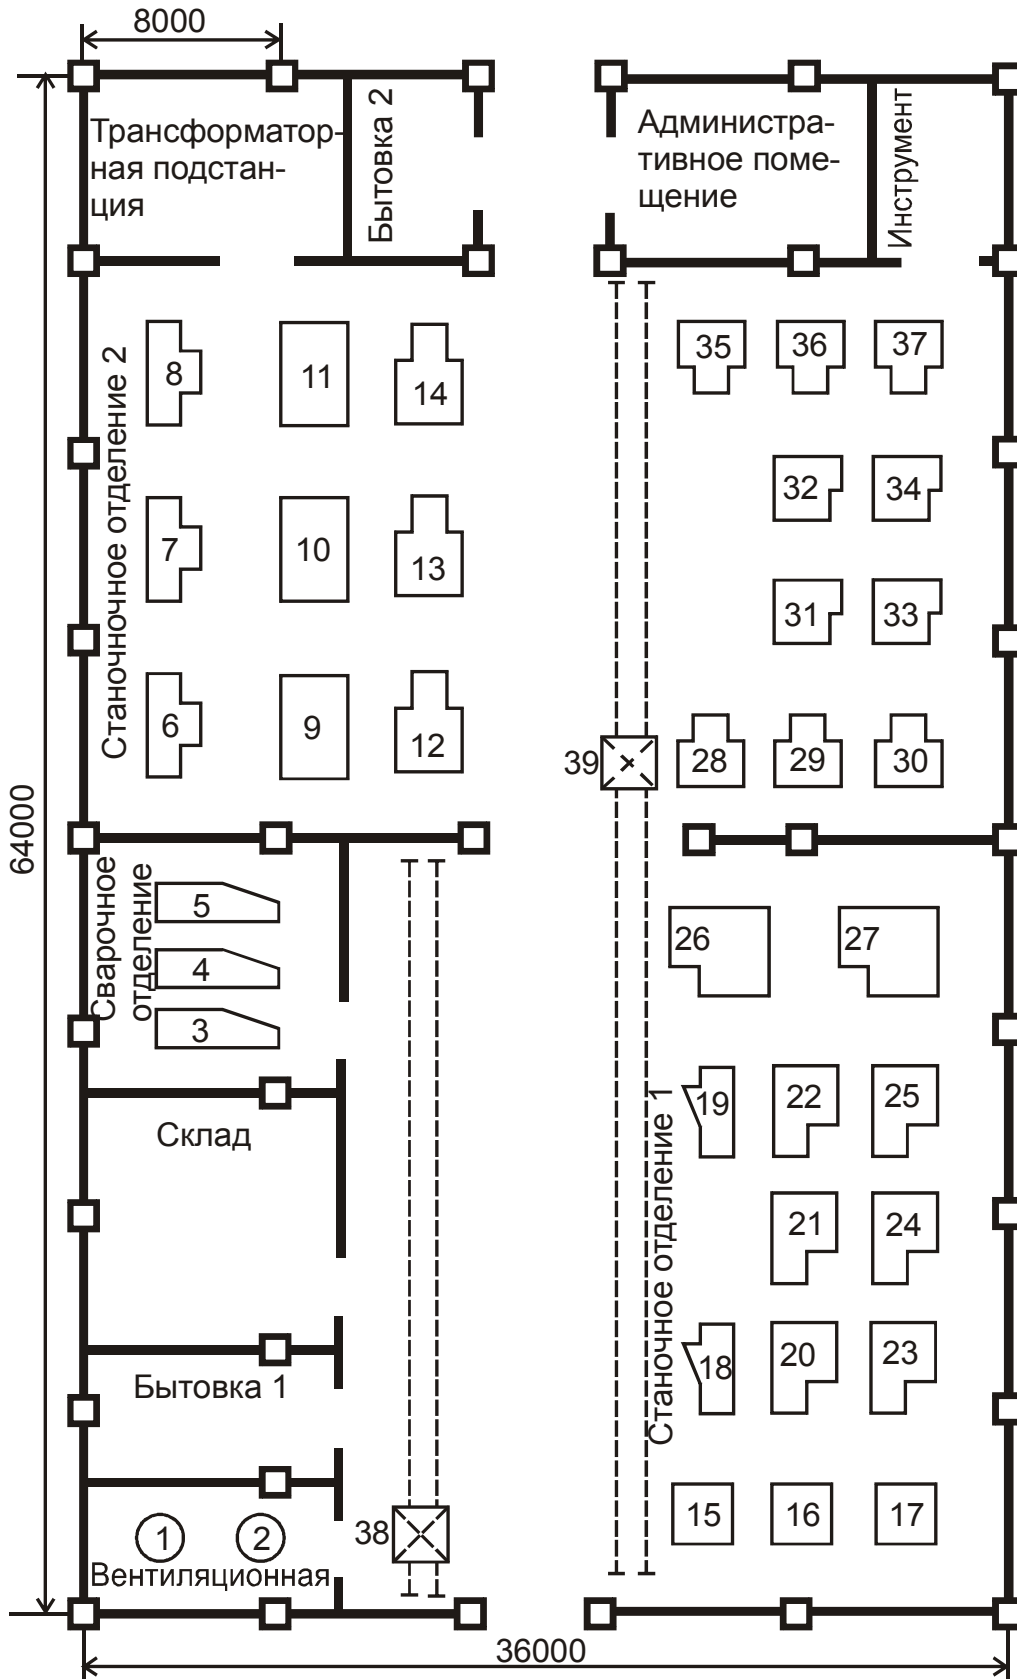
План расположения электрооборудования ремонтно-механического цеха
